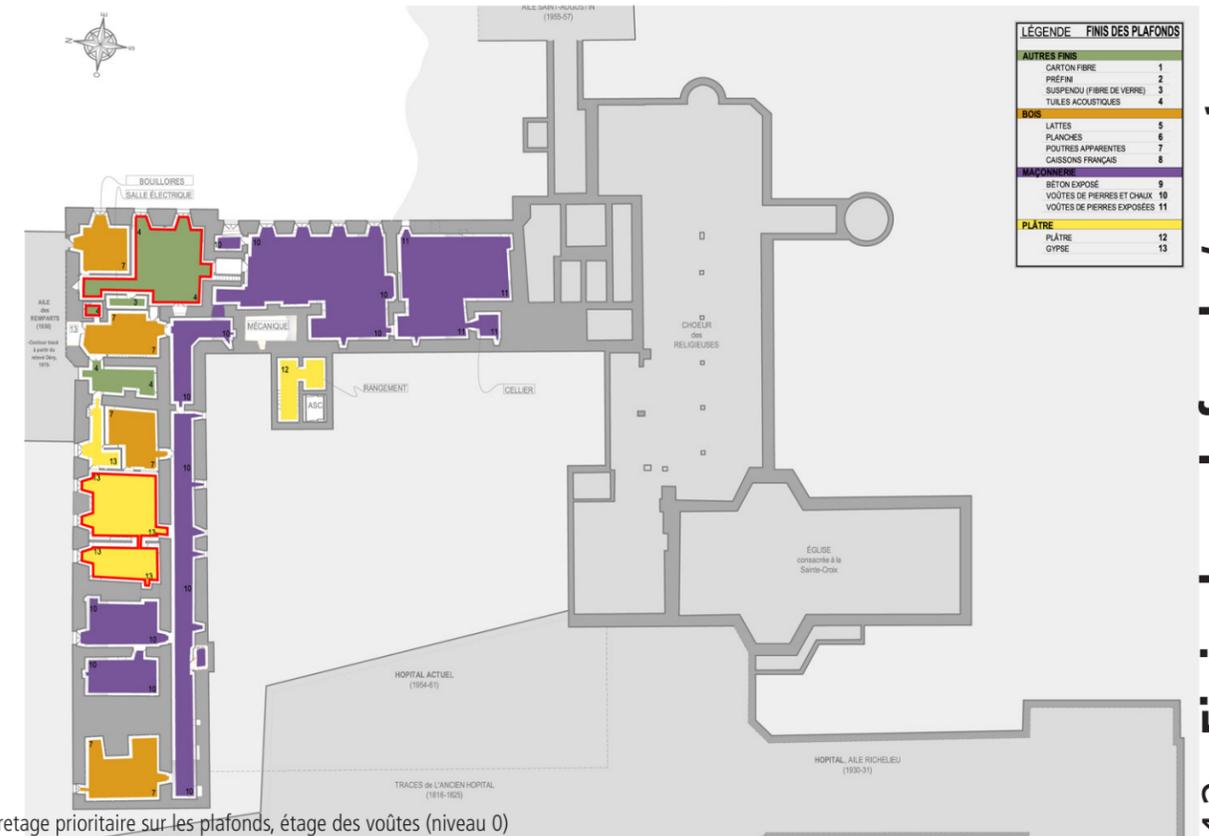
Plan de curetage prioritaire sur les plafonds, étage des voûtes (niveau 0)
